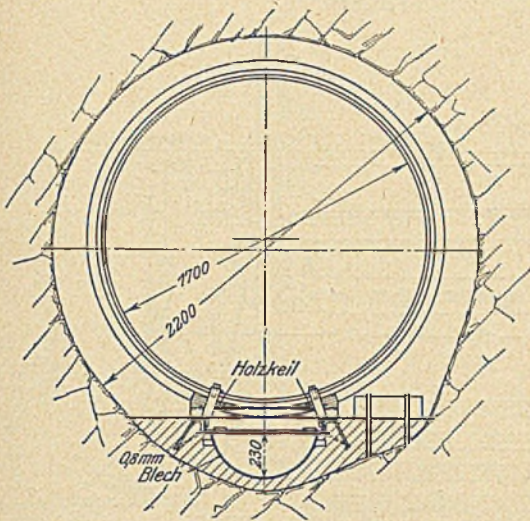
Anordnung im Druckschacht für Gußbeton und Rohrbeförderung.
